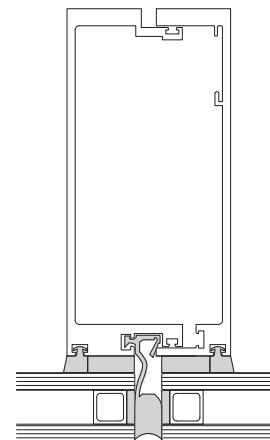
Muro cortina con silicona estructural y junta climática seca burleteada.
